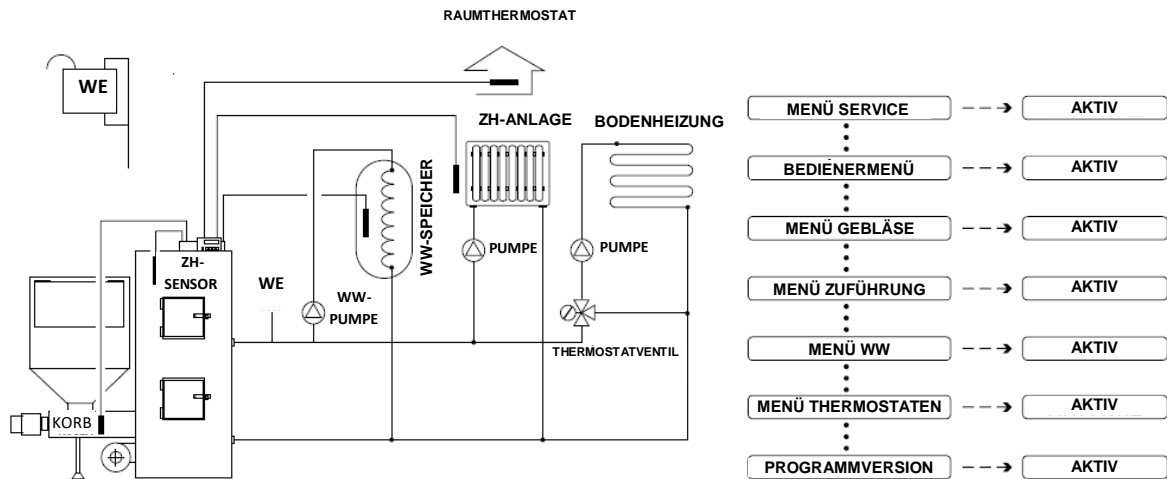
Steuerung des Kessels mit Zuführung – 1 Heizkreis, pumpengesteuert über Raumthermostaten, mit Bodenheizung, die über ein Thermostatventil gesteuert wird und mit einem Warmwasserspeicher.
